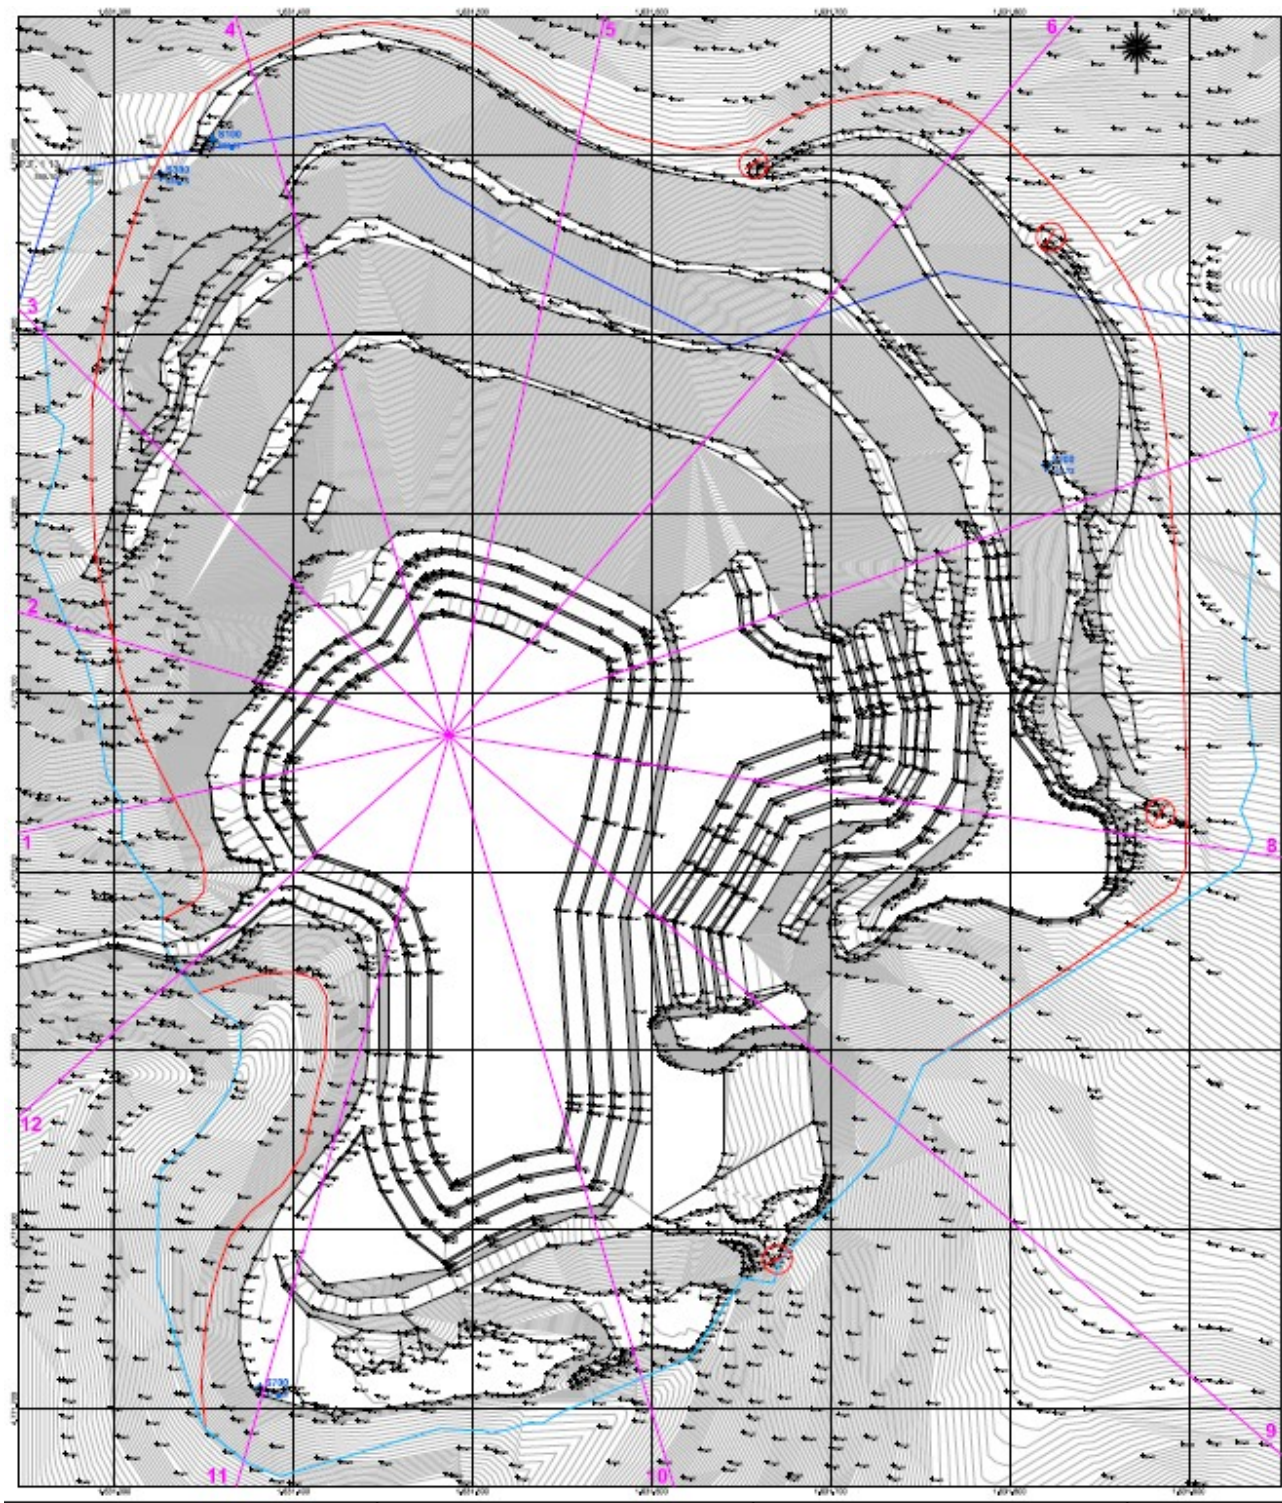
Stato finale escavazione Monte Calvi - AUTORIZZAZIONE UNICA SUAP 2017/469 - E' verificata l'assenza di aree boscate nell'area di escavazione
